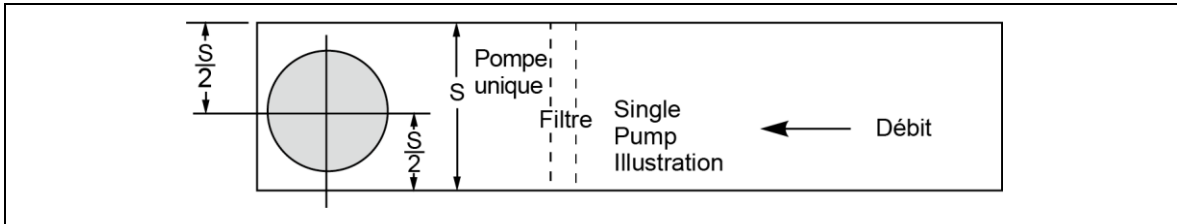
Dimensions du puisard, vue de dessus
